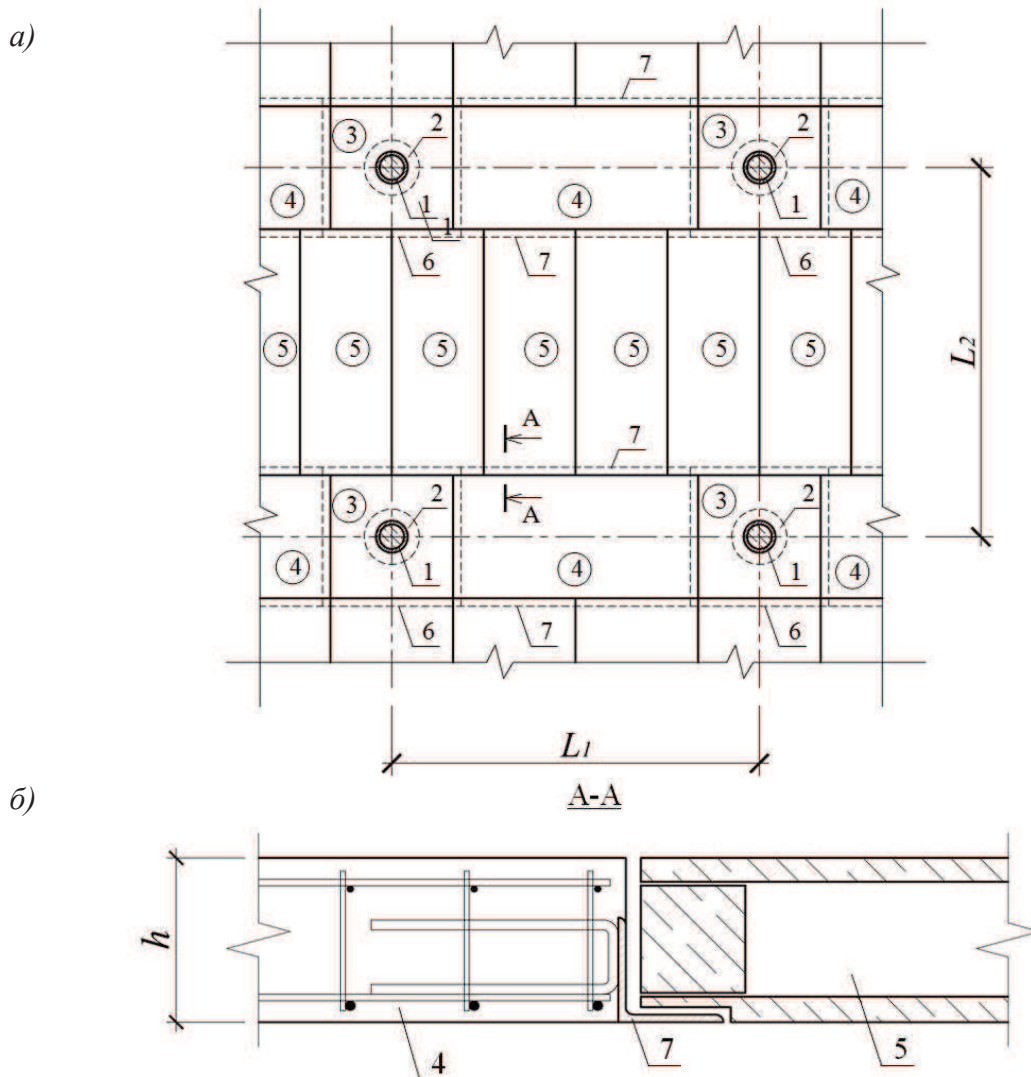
Схема збірного сталезалізобетонного безбалкового перекриття з пустотними плитами
